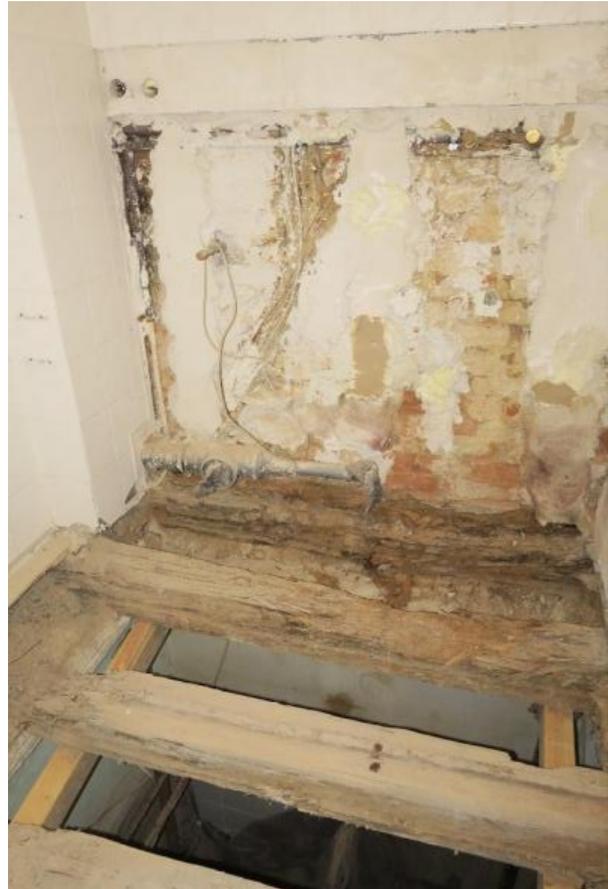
Zimmer im Obergeschoss Hinterhaus Feldstraße 6
